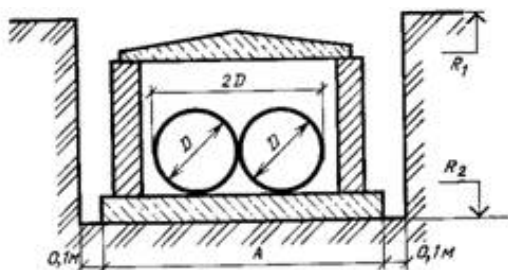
Схема поперечного сечения траншеи для трубопроводов, укладываемых в каналах (крепления не показаны)
